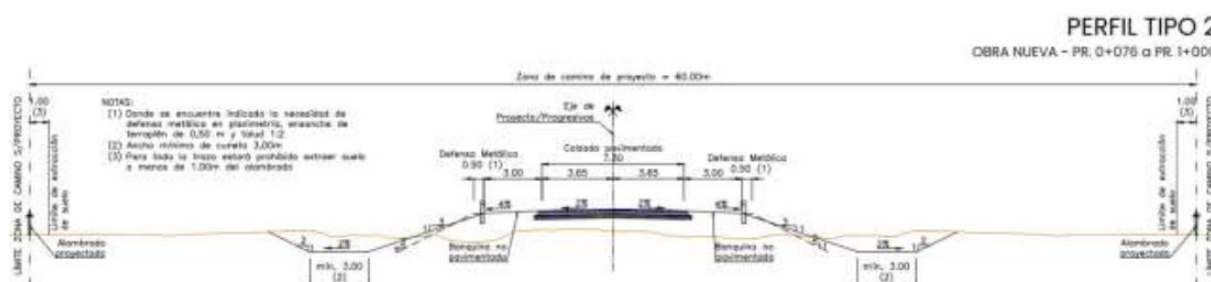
Figura 2. Perfil Tipo 2 – Rural – Obra Nueva - 0+076 a 1+000
